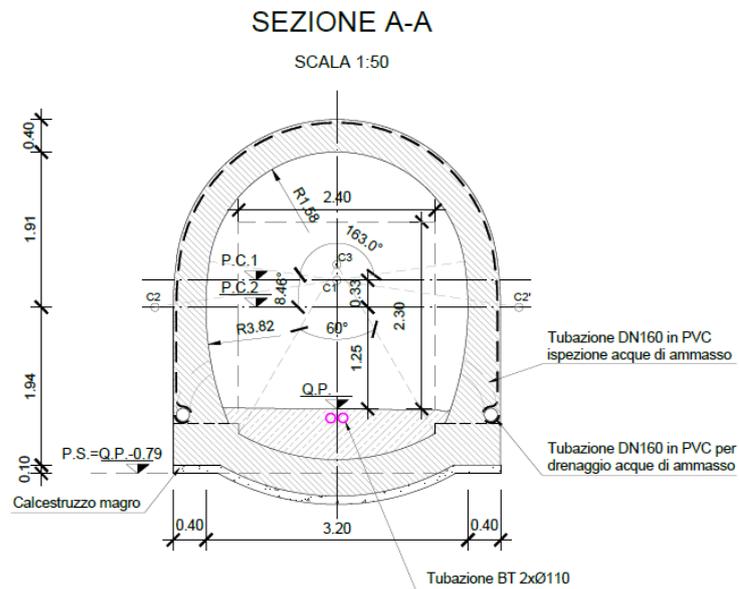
Galleria S. Antonio - Sezione trasversale del by-pass
